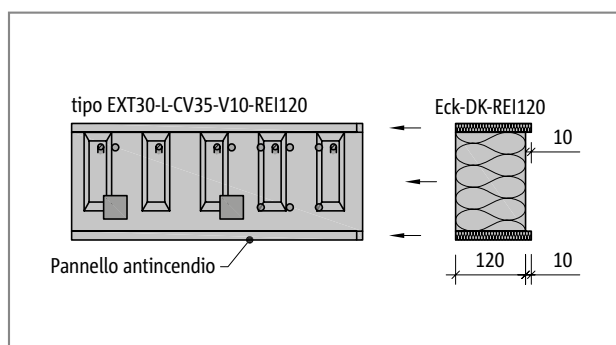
Schöck Isokorb® tipo EXT30-L-CV35, REI120: vista dell'elemento
